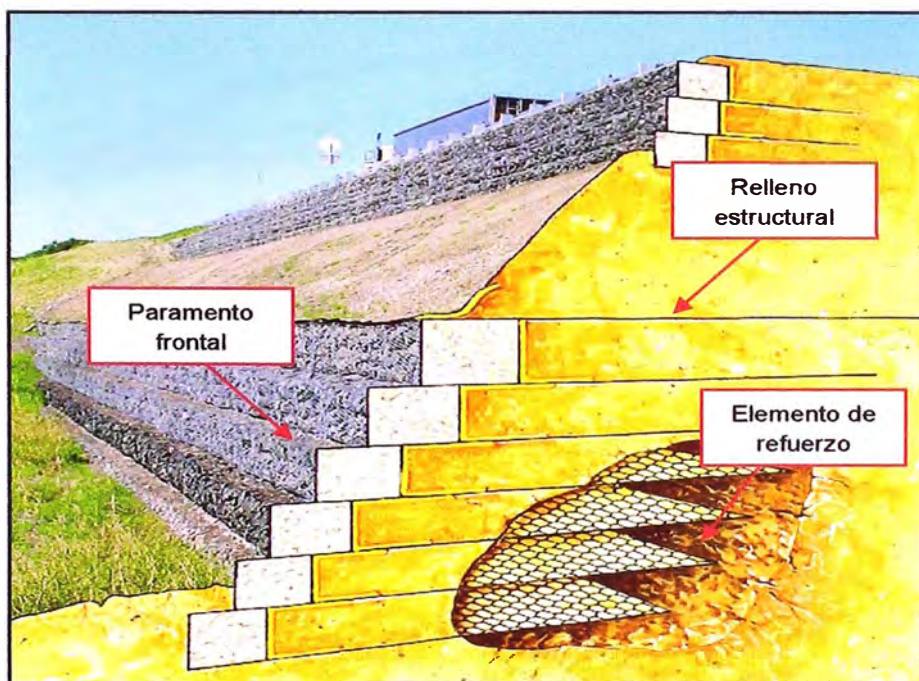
Corte transversal de un muro reforzado con el sistema terramesh
